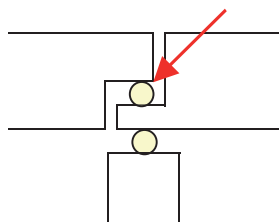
CONEXIÓN RÍGIDA TABLERO/ SUBESTRUCTURA.
